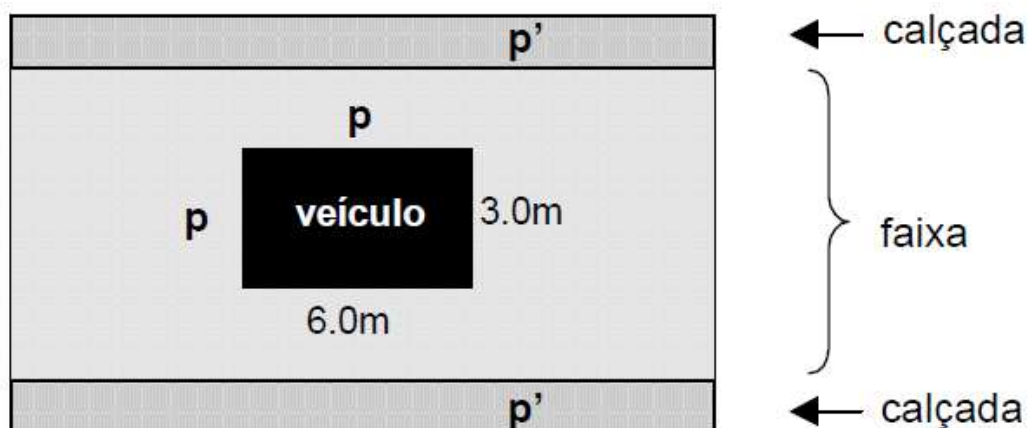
Disposição em planta das cargas móveis (Fonte: Manual de projeto e construção de pontes de madeira – LaMEM)
